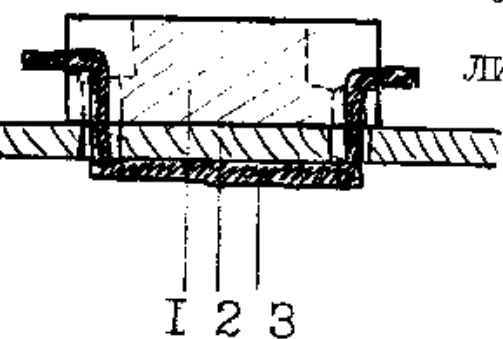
1-патрон, 2-корпус светильника, 3-крепежная скоба.
